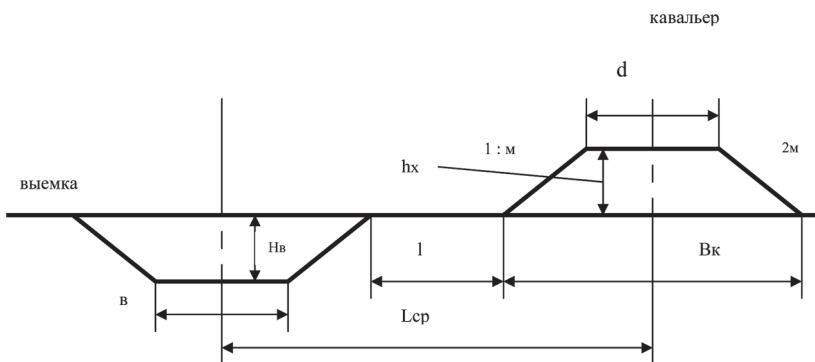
Схема для определения поперечной дальности перемещения грунта из выемок в кавальер
